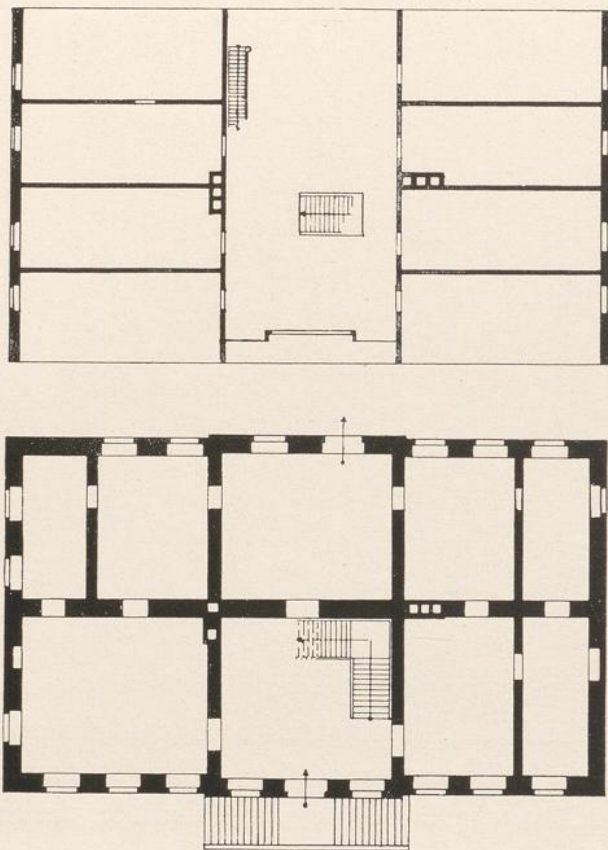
Frauendorf. Obergeschoß u. Erdgeschoß
